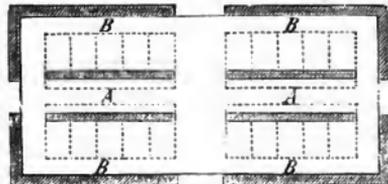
Längsstall für Rindvieh, A Futtergang, B Stallgänge.
